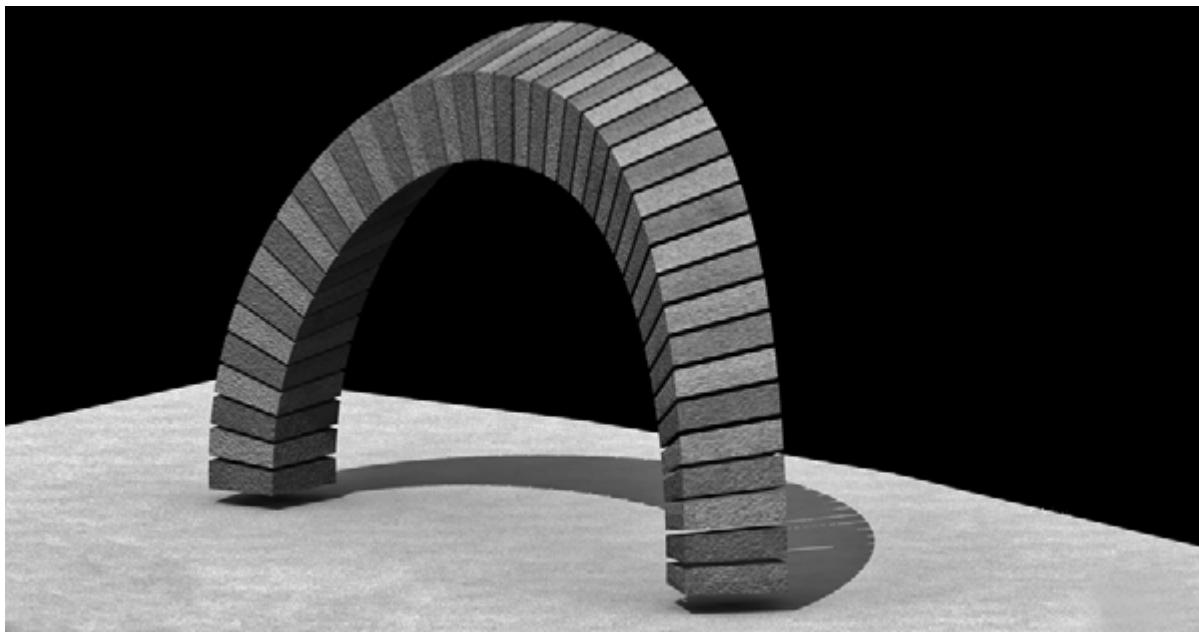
Ricostruzione tridimensionale degli archi della chiesa di Loyola, vista assonometrica (elaborazione di I. Benincampi).
